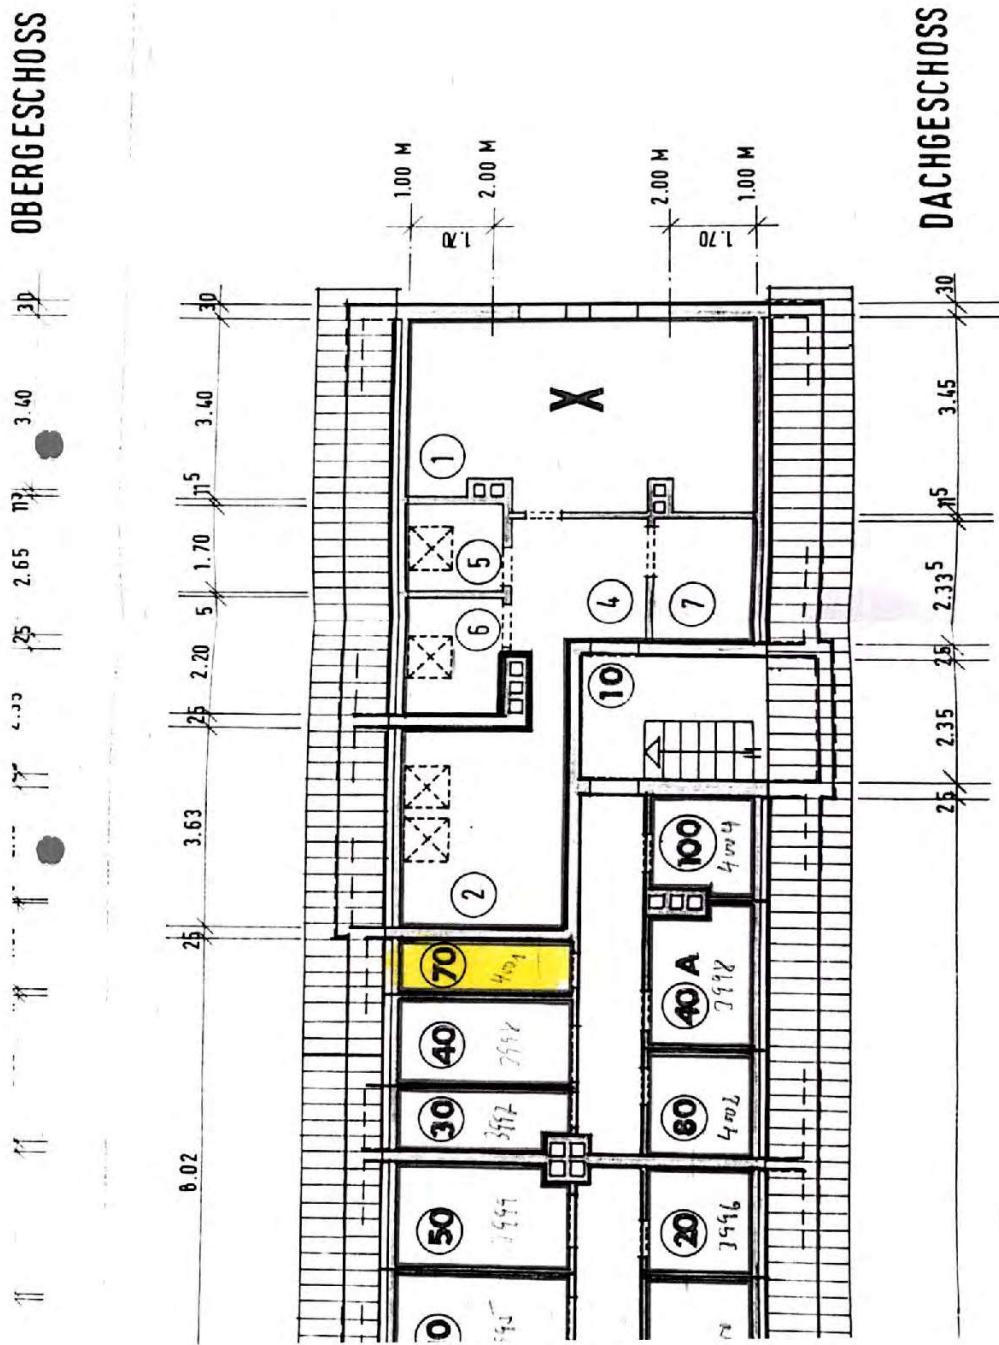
Teilgrundriss DG mit Kennzeichnung zugehöriger Bodenraum
